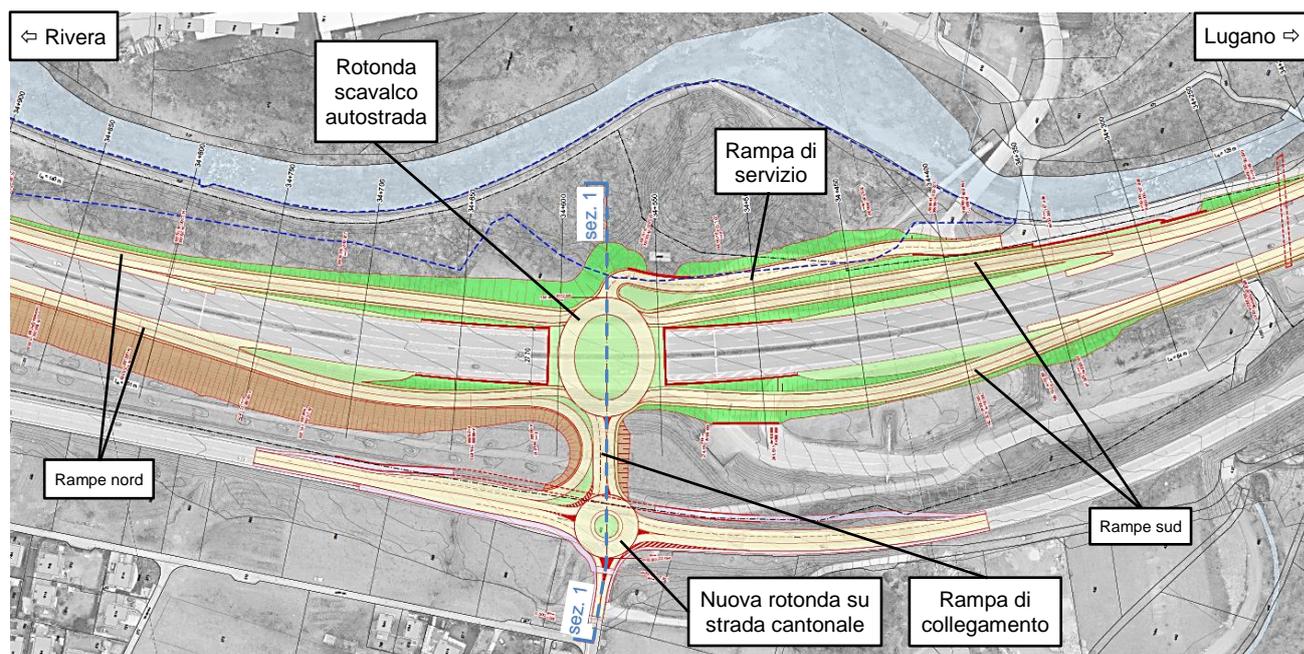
planimetria dello svincolo autostradale a diamante con la rotonda ovoidale di scavalco all'autostrada e la nuova rotonda all'incrocio con la strada cantonale. Le rotonde sono unite da una rampa di collegamento e, verso il fiume Vedeggio, vi è la rampa di servizio.
